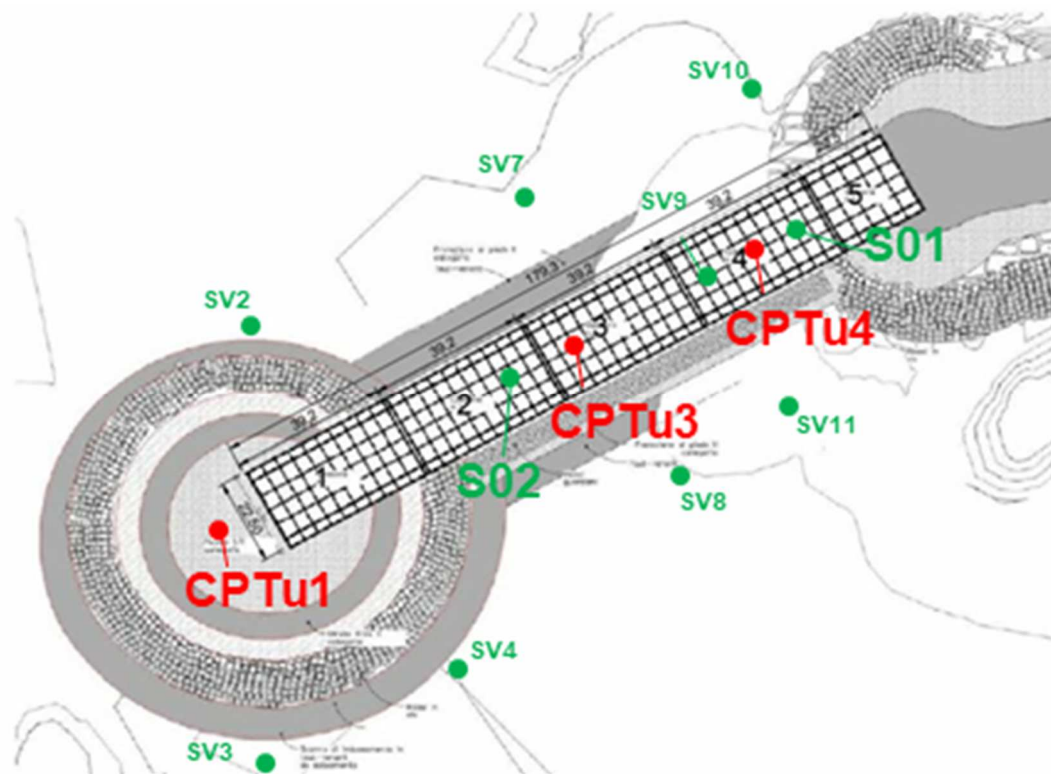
Planimetria esecuzione sondaggi e prove
